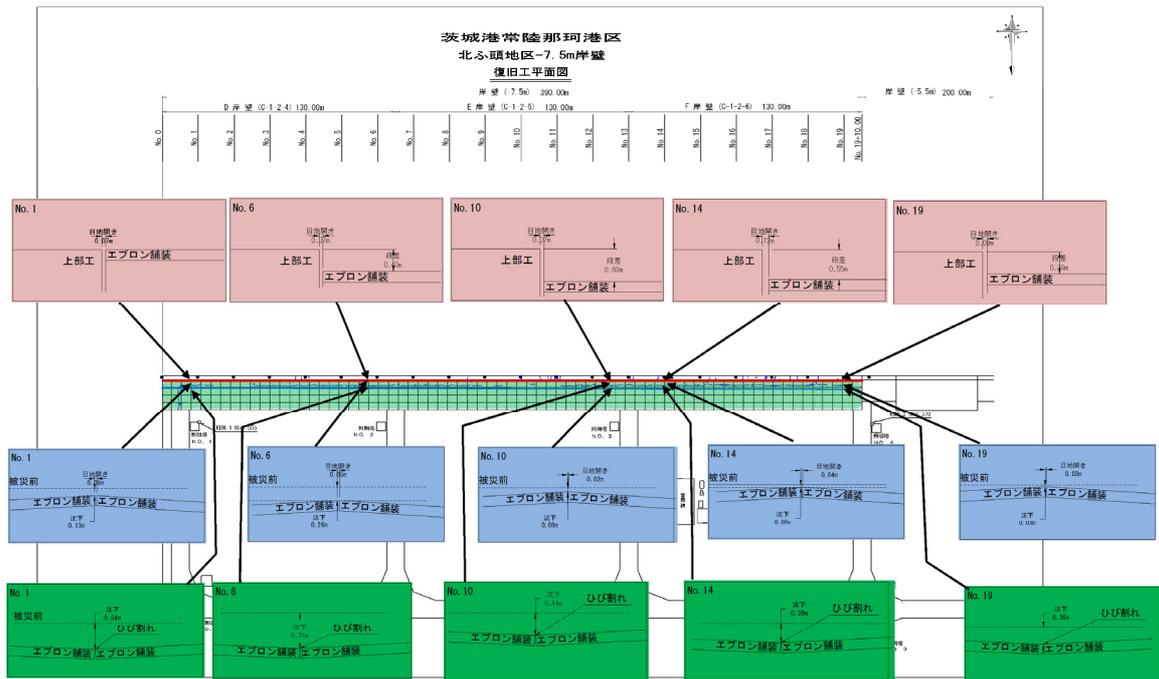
212 No.16 常陸那珂港区_北埠頭地区 D・E・F岸壁 (-7.5m) の平面図 (被災後)
